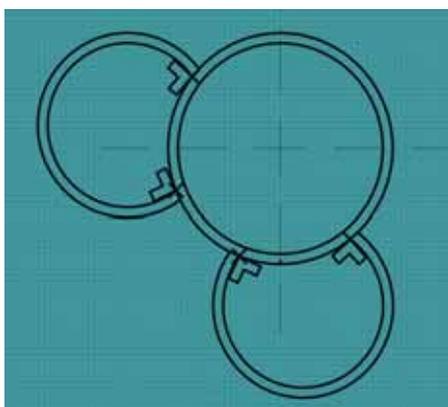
Схема стыковки базовых элементов с направляющими трубами
